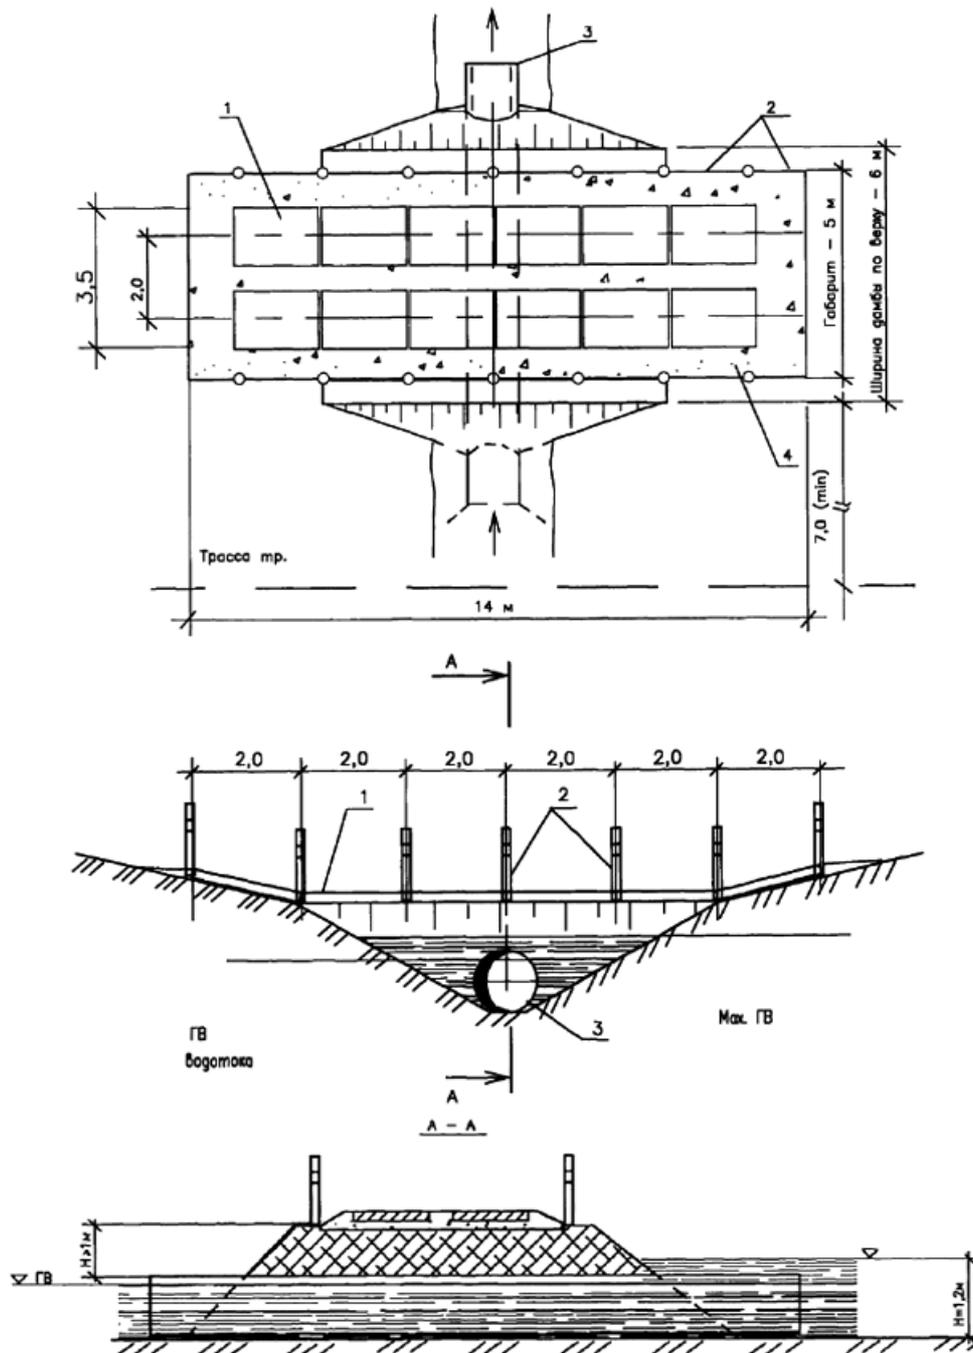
Схема переезда через малый водоток с покрытием из ж.б. плит 2П30.18
